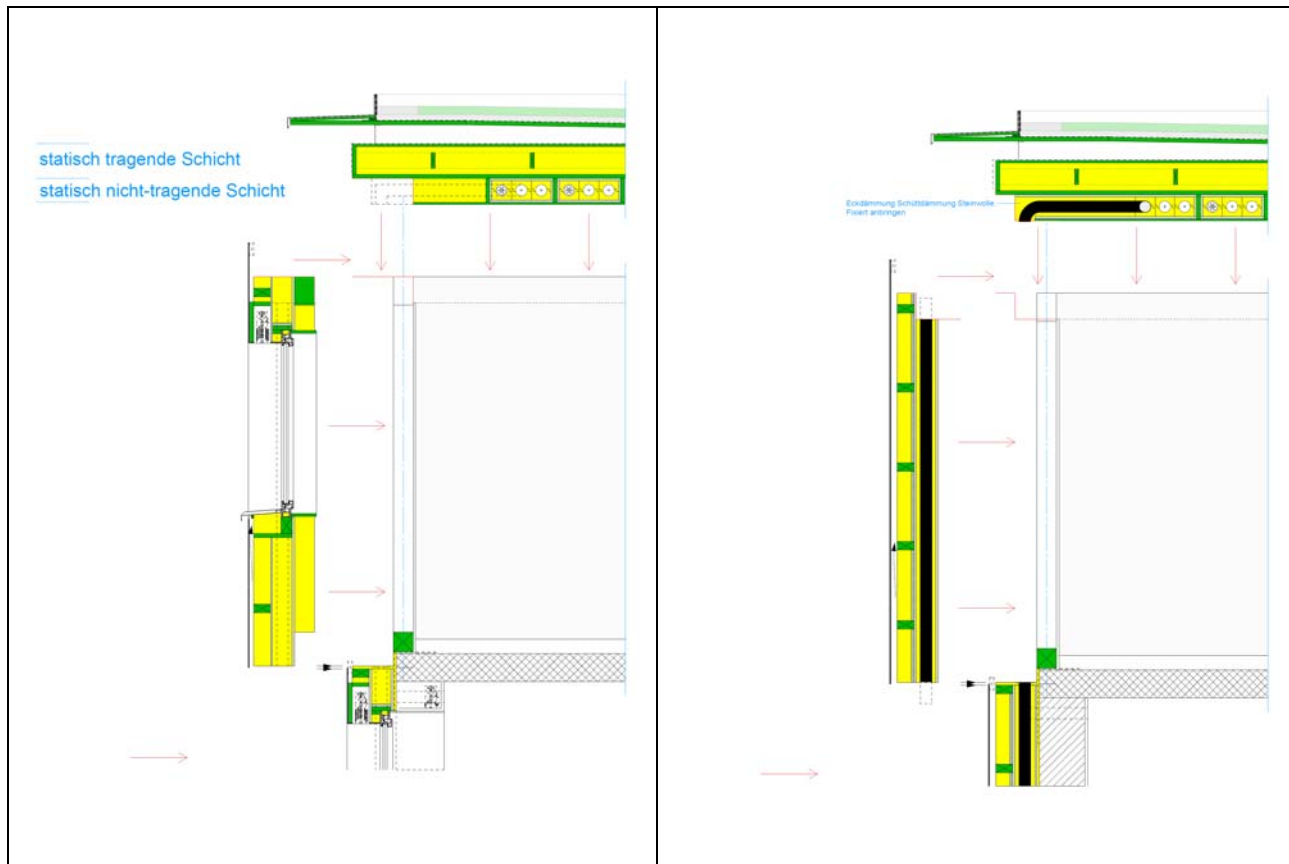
Schnitte Zusammenbau Fassade- und Flachdachelement bei Aufstockung in Leichtbauweise, Bereich Fenster und Bereich Lüftungsleitungen
